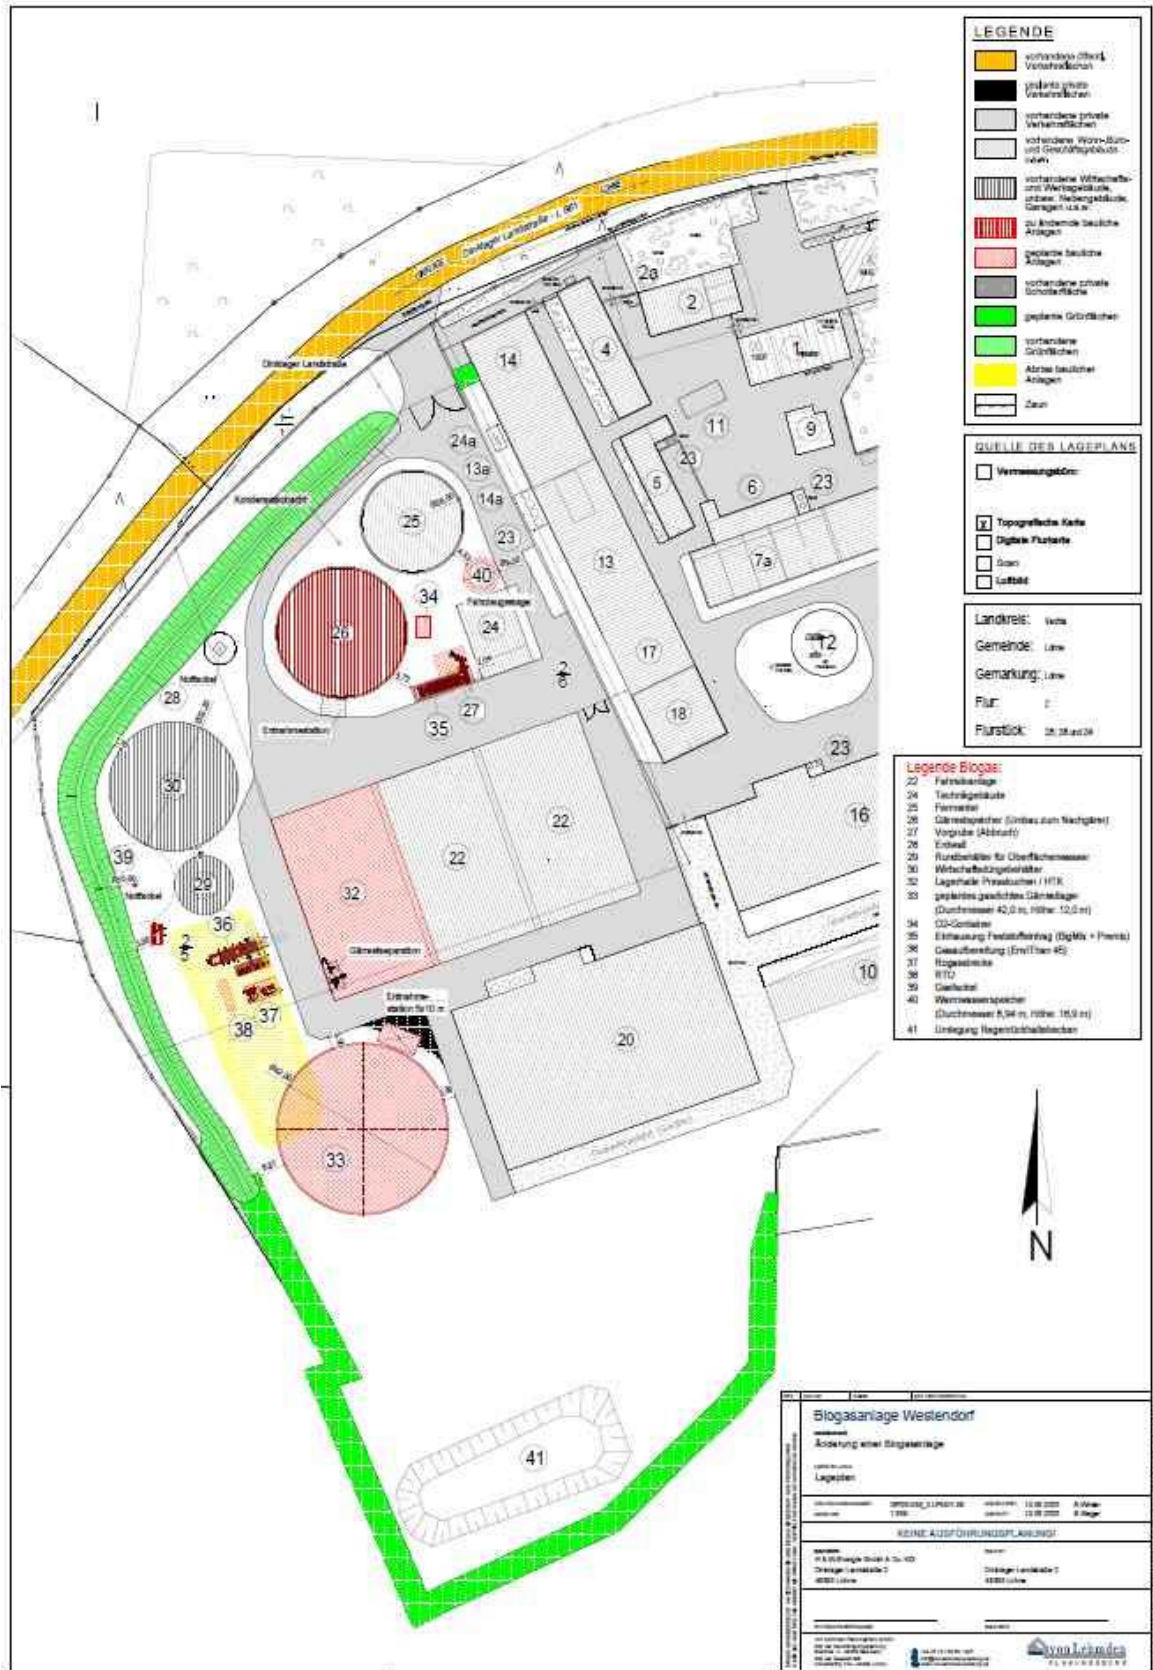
Einfacher Lageplan des Sondergebietes Biomethan, Dinklager Landstraße 2, Stadt Lohne (Entwurf, Stand: 13.05.2025).
